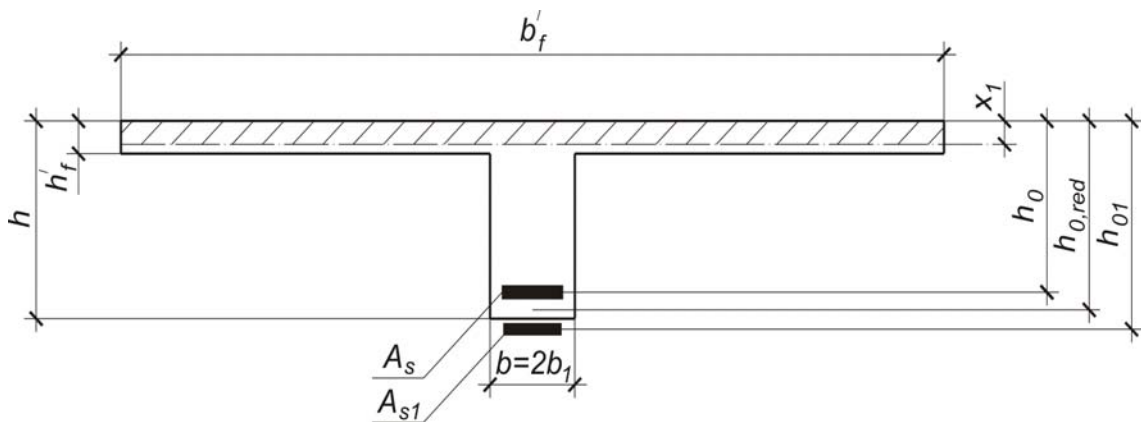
К расчету усиления нормального сечения плиты способом дополнительного армирования:
